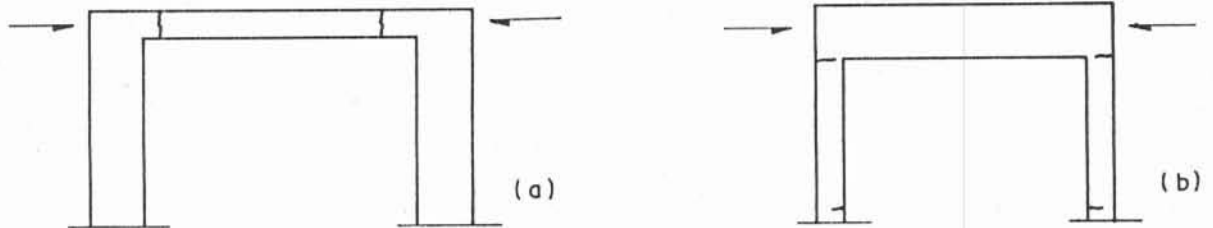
Fissuras produzidas por retração hidráulica de viga em pórtico de pilares (a) de grande rigidez e (b) de pequena rigidez (CANOVAS<sup>36</sup>).
